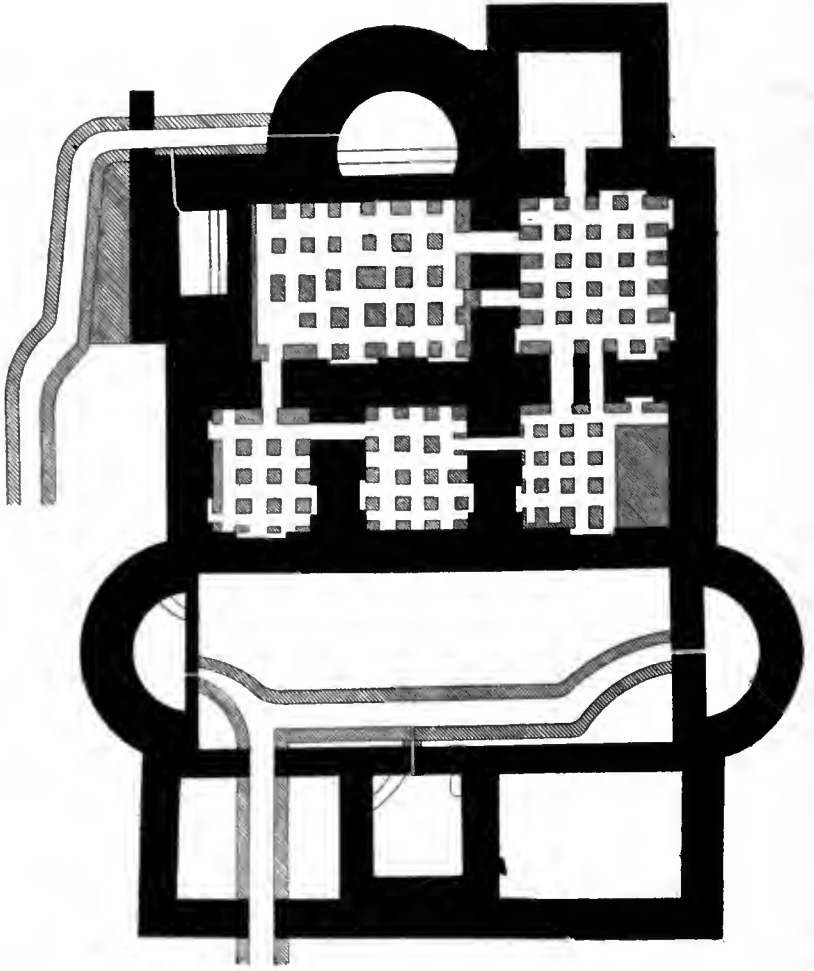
Bains de Doshéh. Plan des constructions souterraines.
